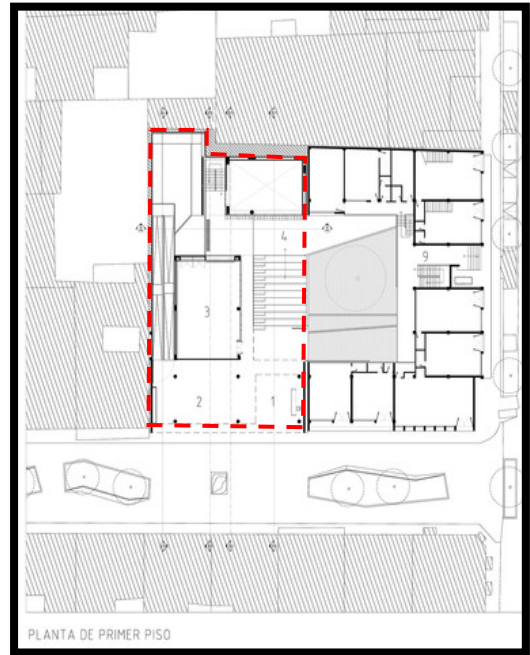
Planta de distribución, recuperado de <http://www.archdaily.pe>
